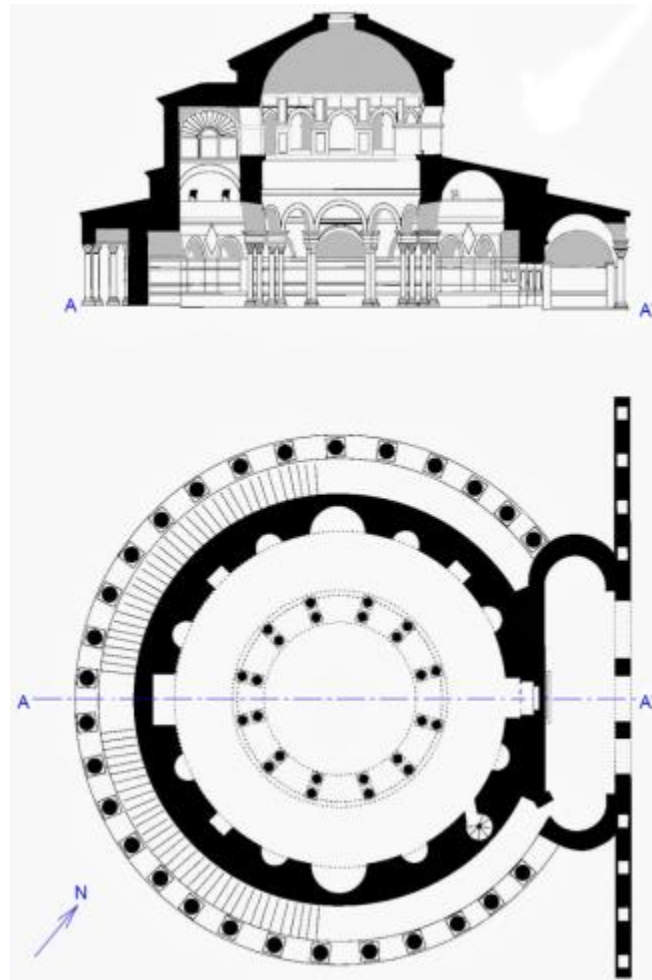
Alzado y planta del Mausoleo de Santa Constanza, Roma, siglo IV.
